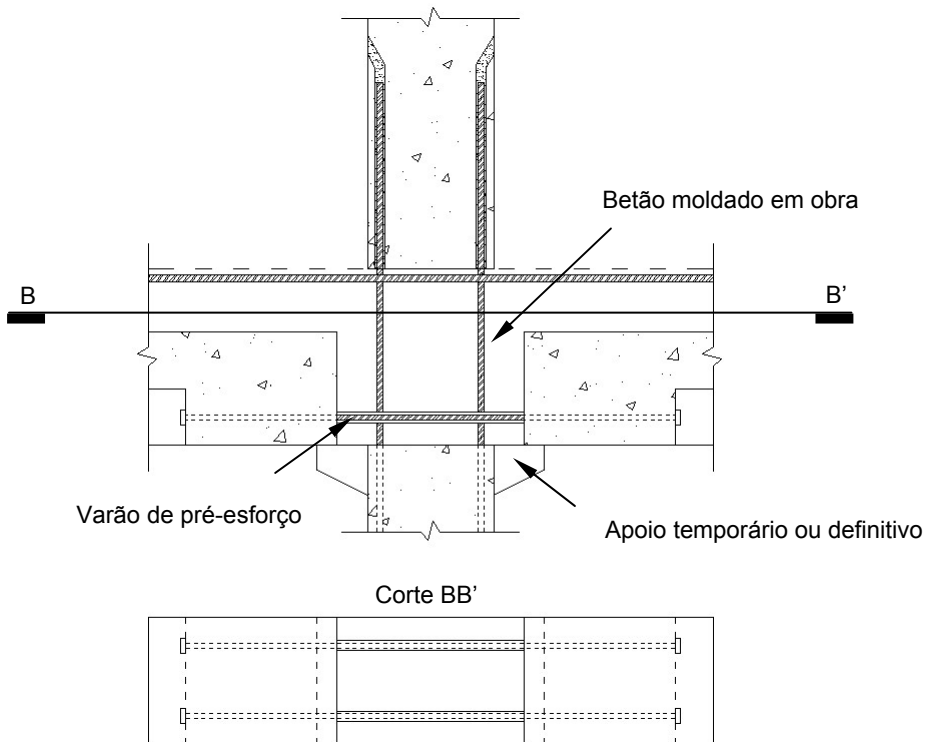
Ligação viga – pilar com recurso a pré-esforço
